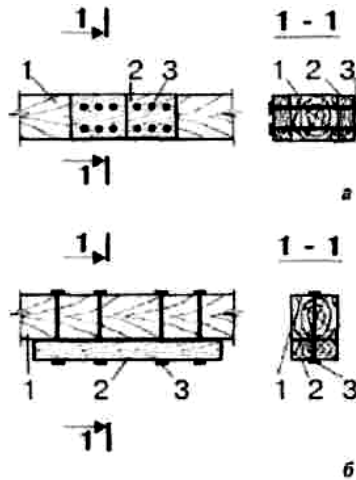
Схеми підсилення дерев'яних балок різними накладками:
